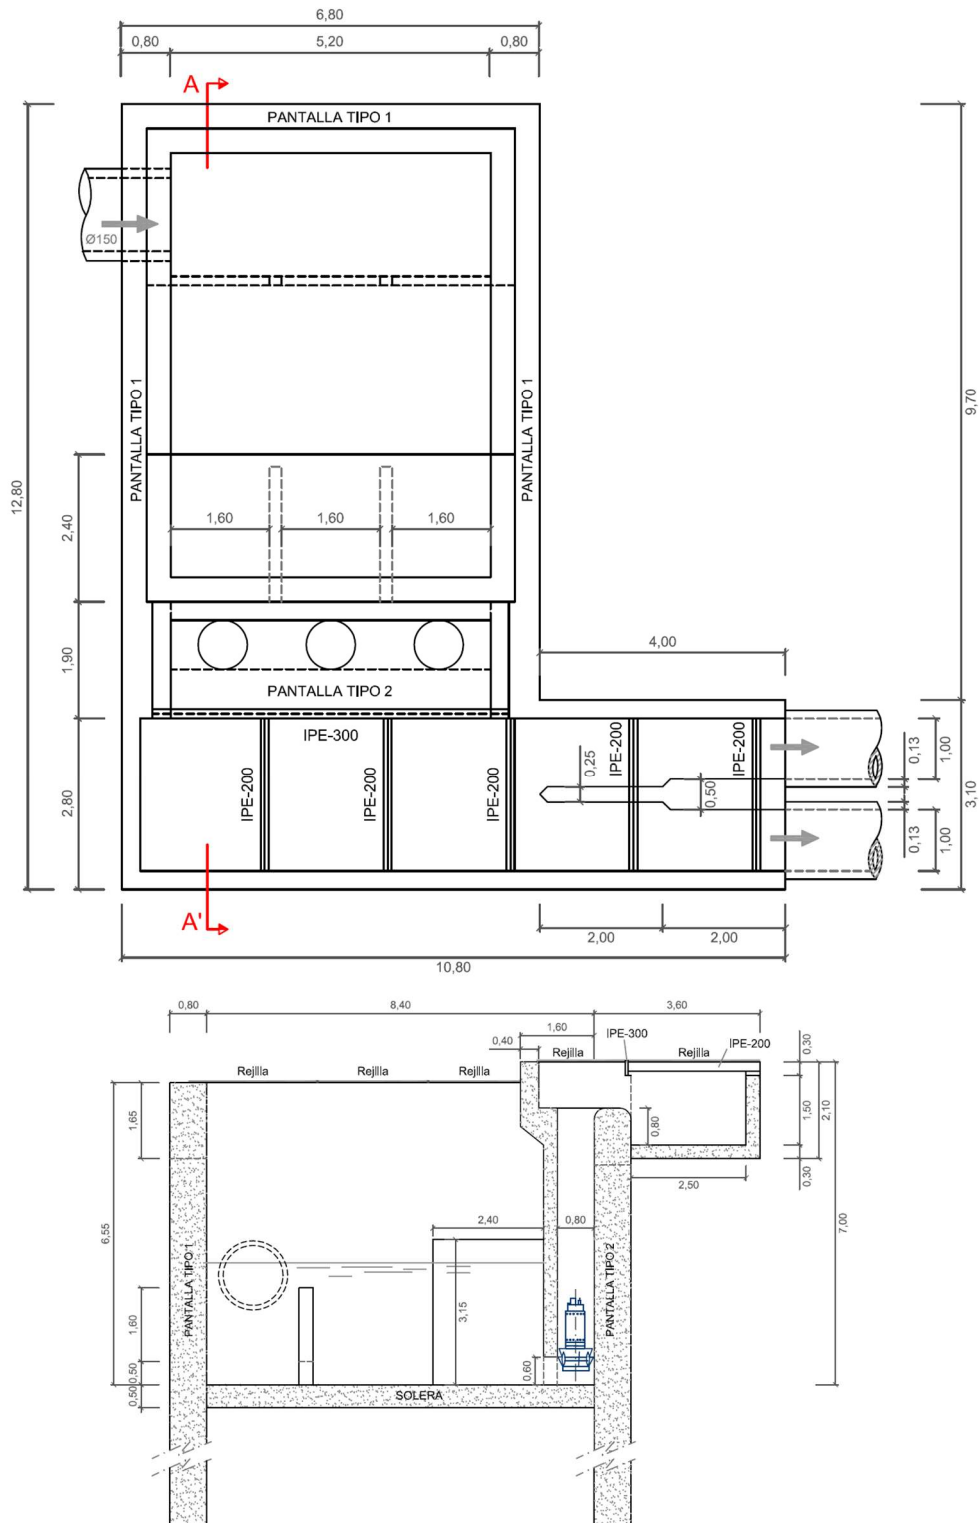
A planta y sección A-A' Estación de bombeo
